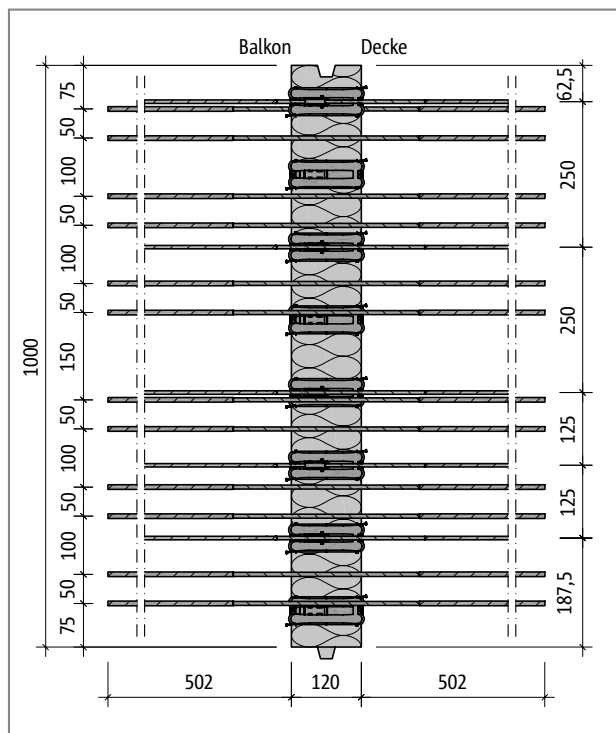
Schöck Isokorb® XT Typ K-M4: Produktgrundriss
